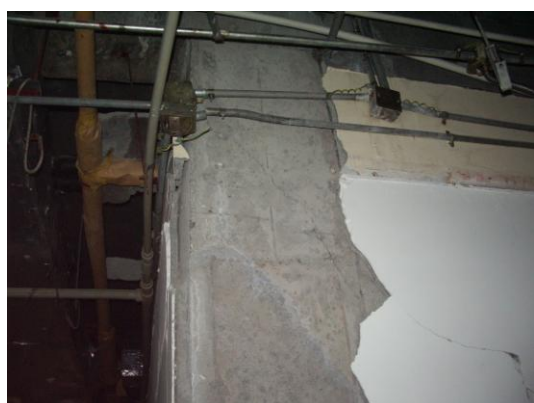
柱頭せん断ひび割れ（損傷度Ⅲ）
